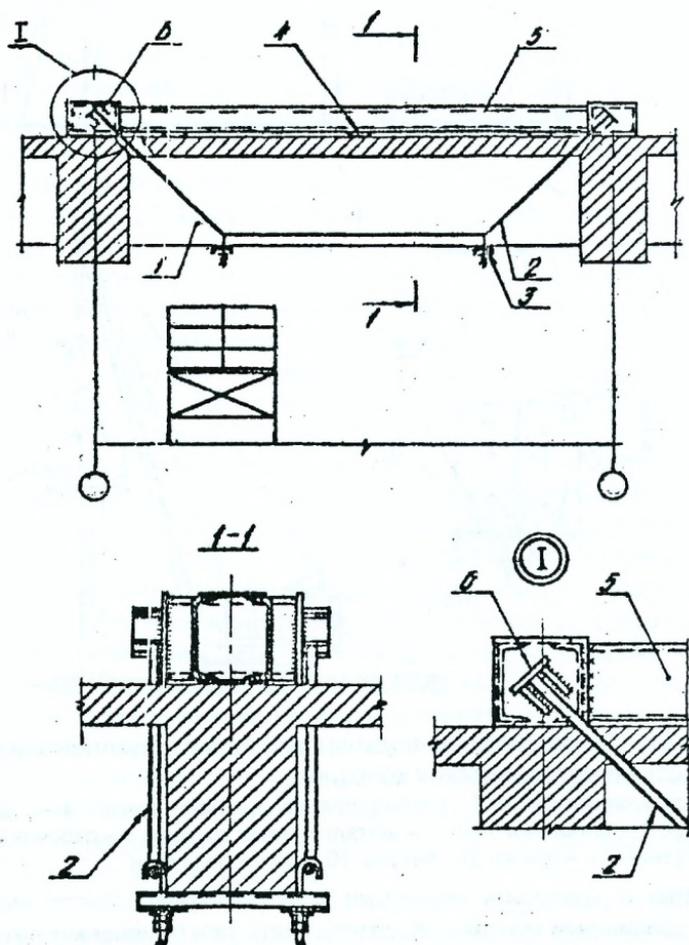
Схема усиления шпрингельной затяжкой с закреплением на металлической балке:
